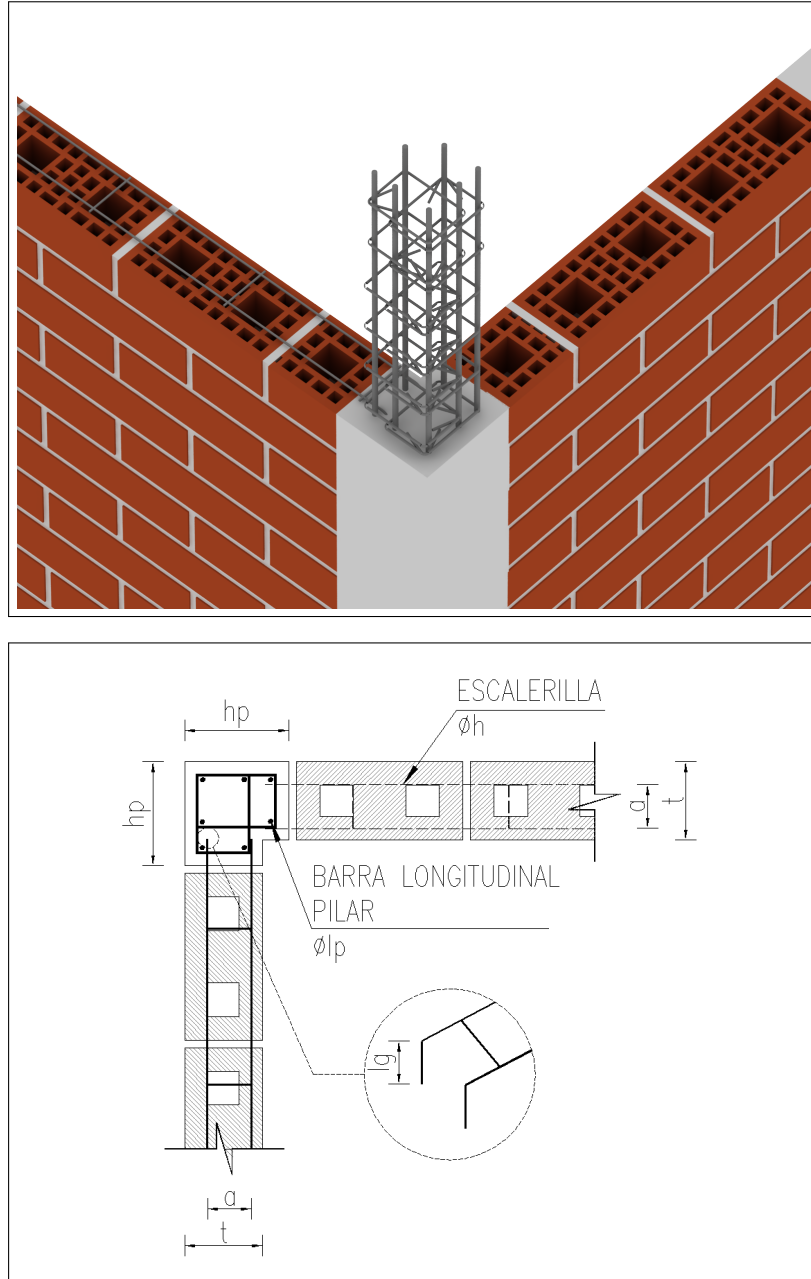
Detalle de las escalerillas para el encuentro de muros en L
